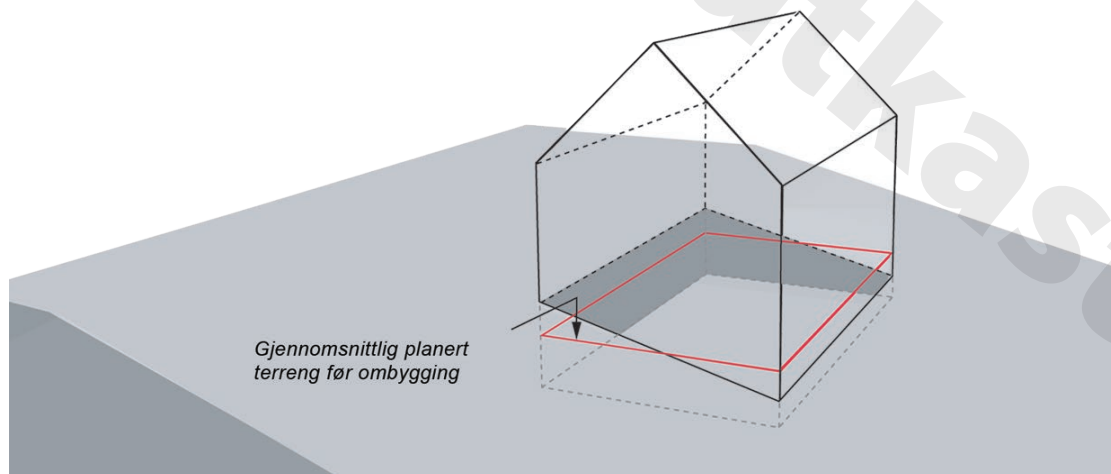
Bruksareal regnes for alle måleverdige plan, inklusive plan helt eller delvis under terreng
